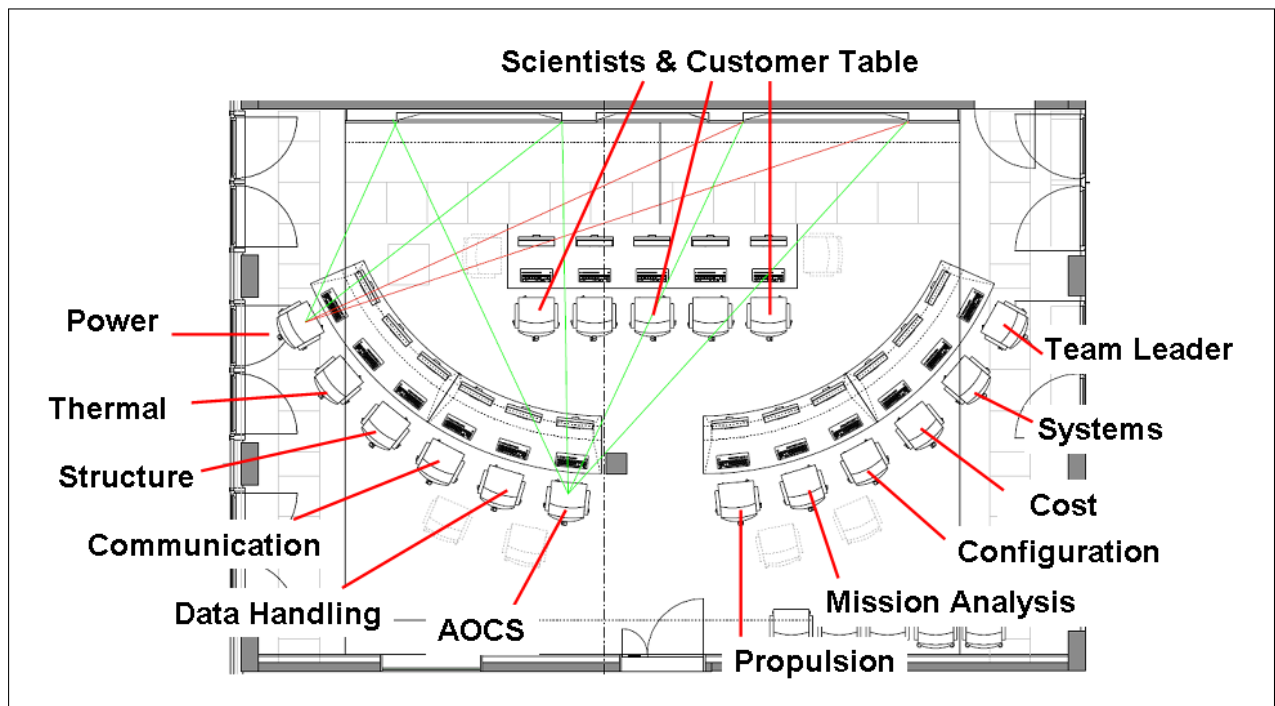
Grundriss vom Hauptraum der CEF des DLR Bremen (Quelle: DLR)
